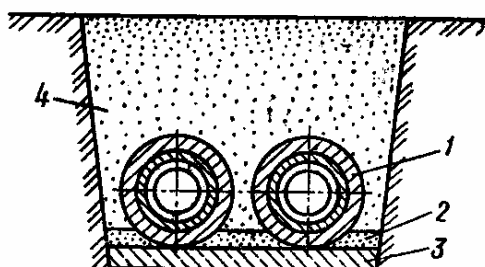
Бесканальная прокладка теплопроводов в монолитных оболочках из армированного пенобетона
